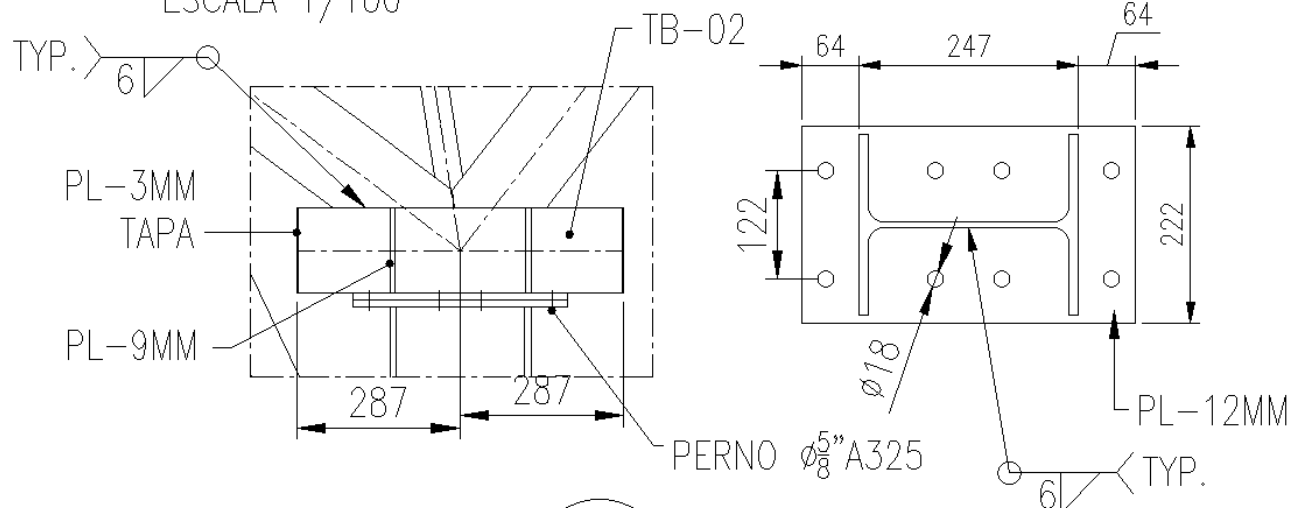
IMAGEN:DETALLE DE ARRIOSTRE ENTRE COLUMNA Y CERCHA
